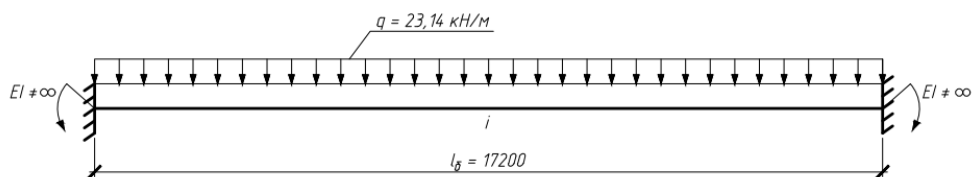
Расчетная схема клееной балки с опорами конечной жесткости
